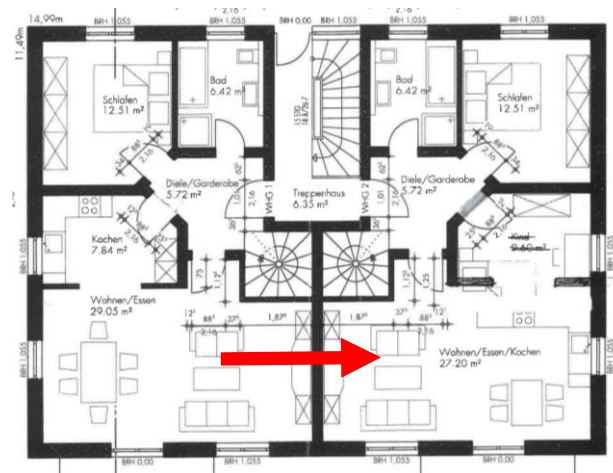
Grundriss mit Angabe der Messrichtung (roter Pfeil)
